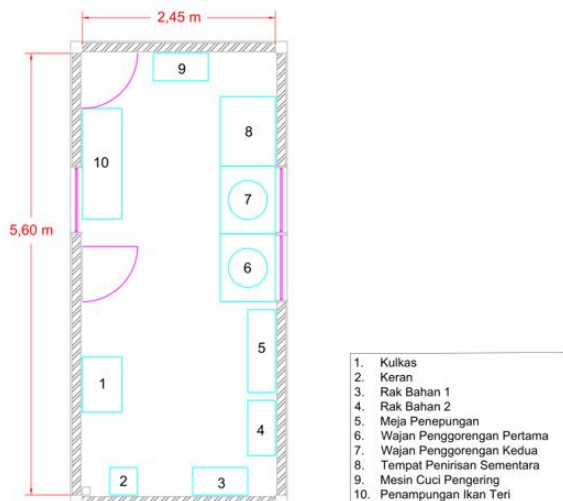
Layout Usulan Untuk Wilayah Kerja 5
